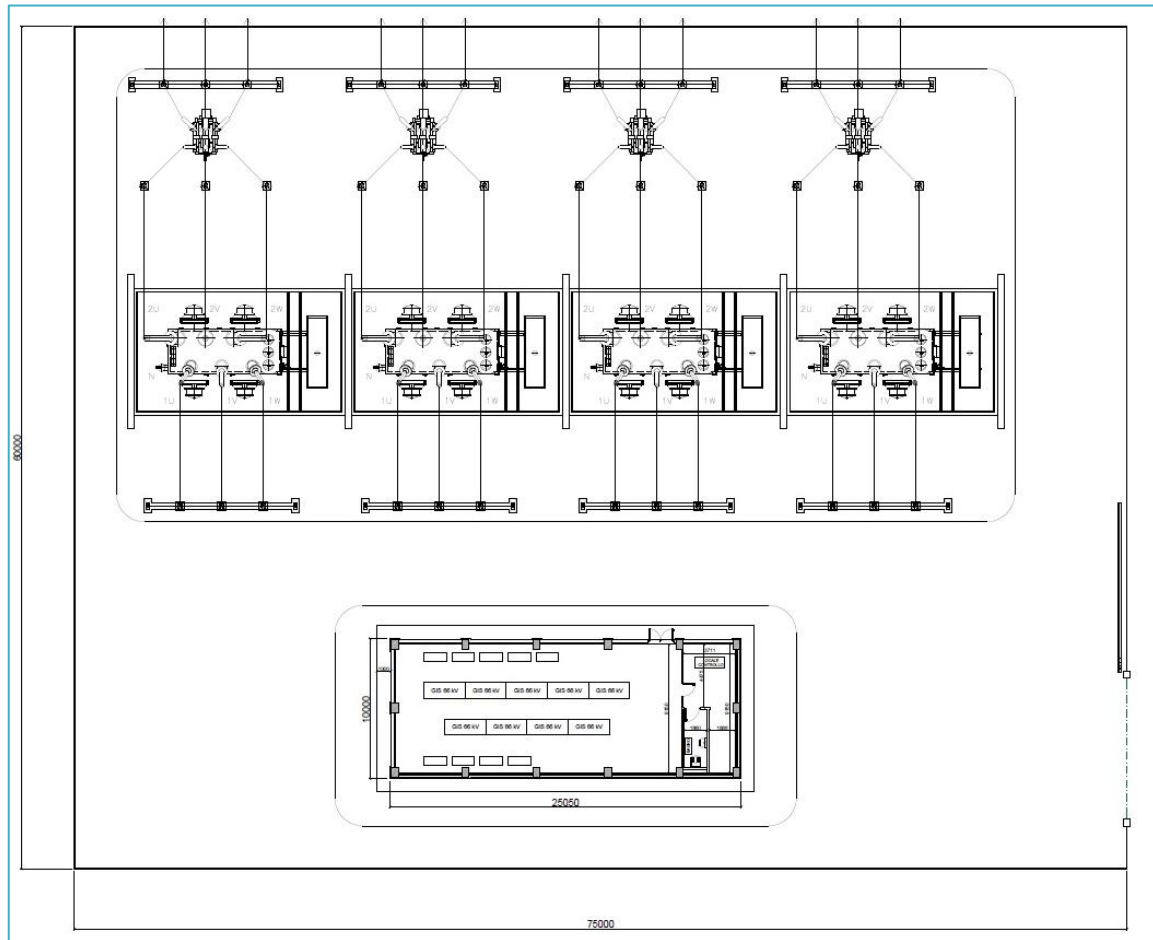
Vista in pianta (tipico) Stazione di Sezionamento e Trasformazione
